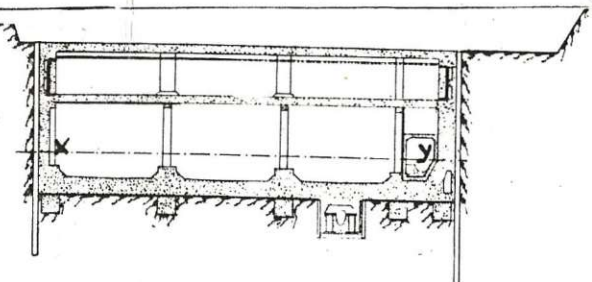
a) Enlèvement de l'étaçon intermédiaire X Y; b) Ferrailage et bétonnage successif du restant de l'ouvrage; c) Travaux divers de parachèvement.
